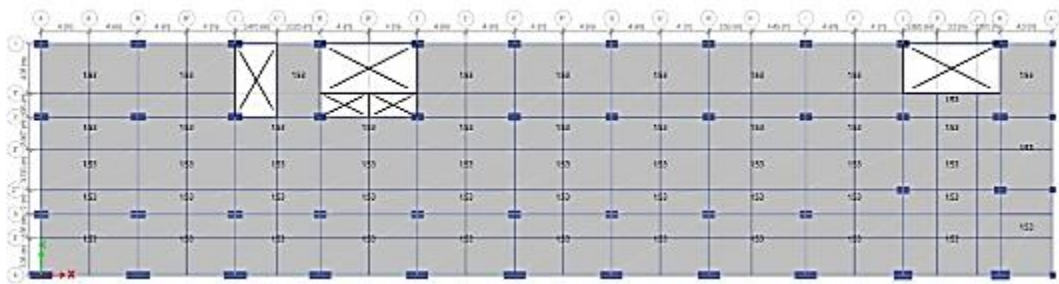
Cara memasukkan beban mati tambahan pada pelat lantai.
